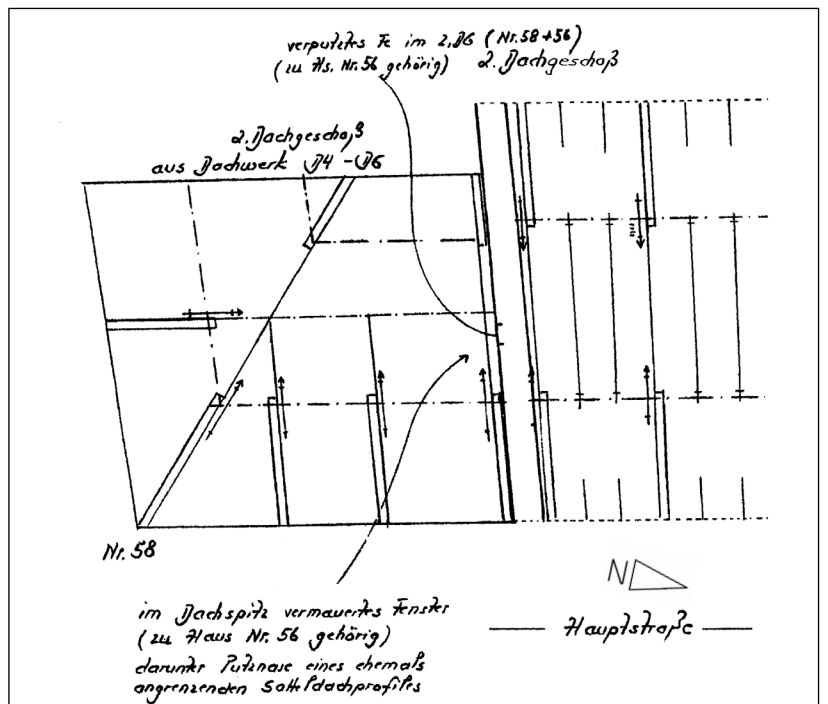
Hauptstraße 58, Grundrisssskizze 1. Dachgeschoss.
